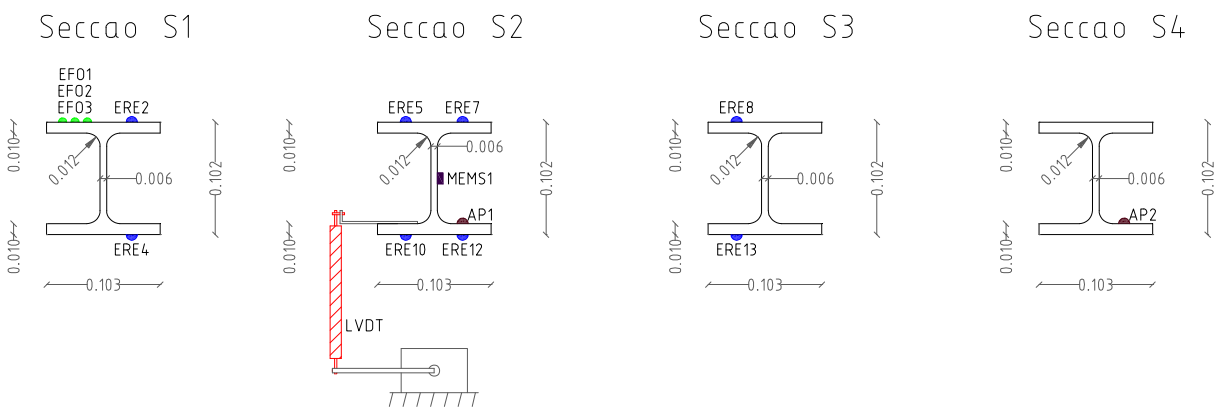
Secções transversais e rede de sensores instalada.
